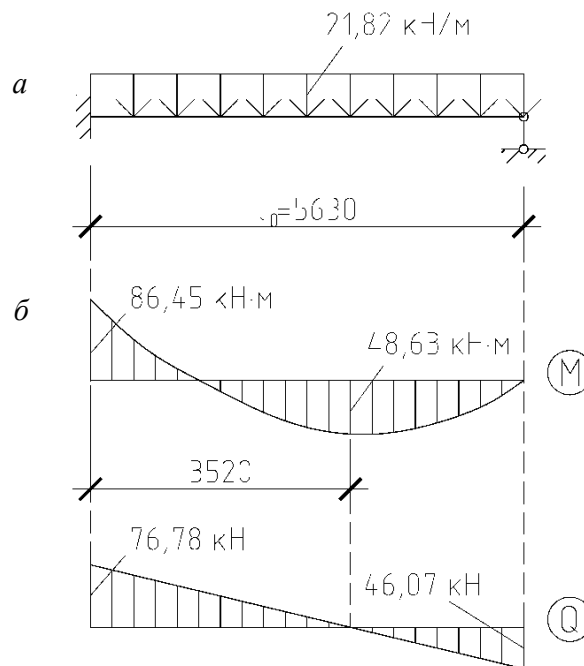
К расчёту плиты перекрытия крайнего пролёта:
